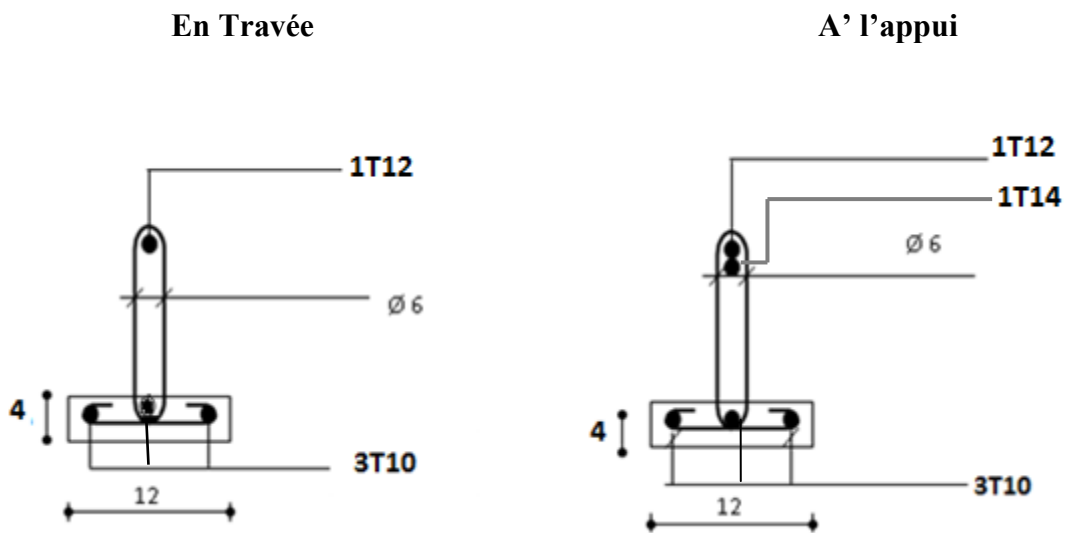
Ferrailage des poutrelles sur le plancher Terrasse
